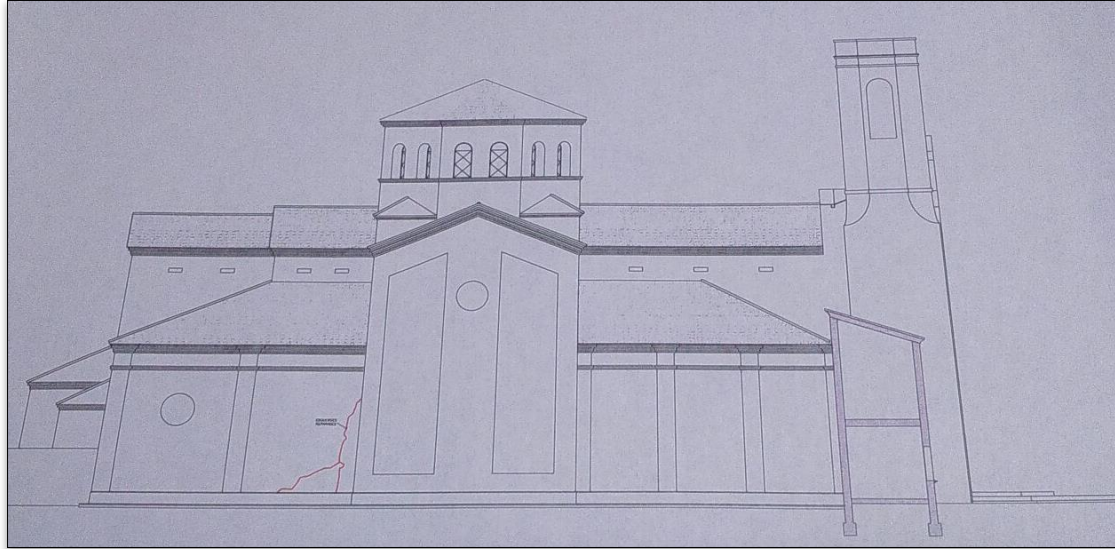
Plano grietas fachada oeste (año 2012)
